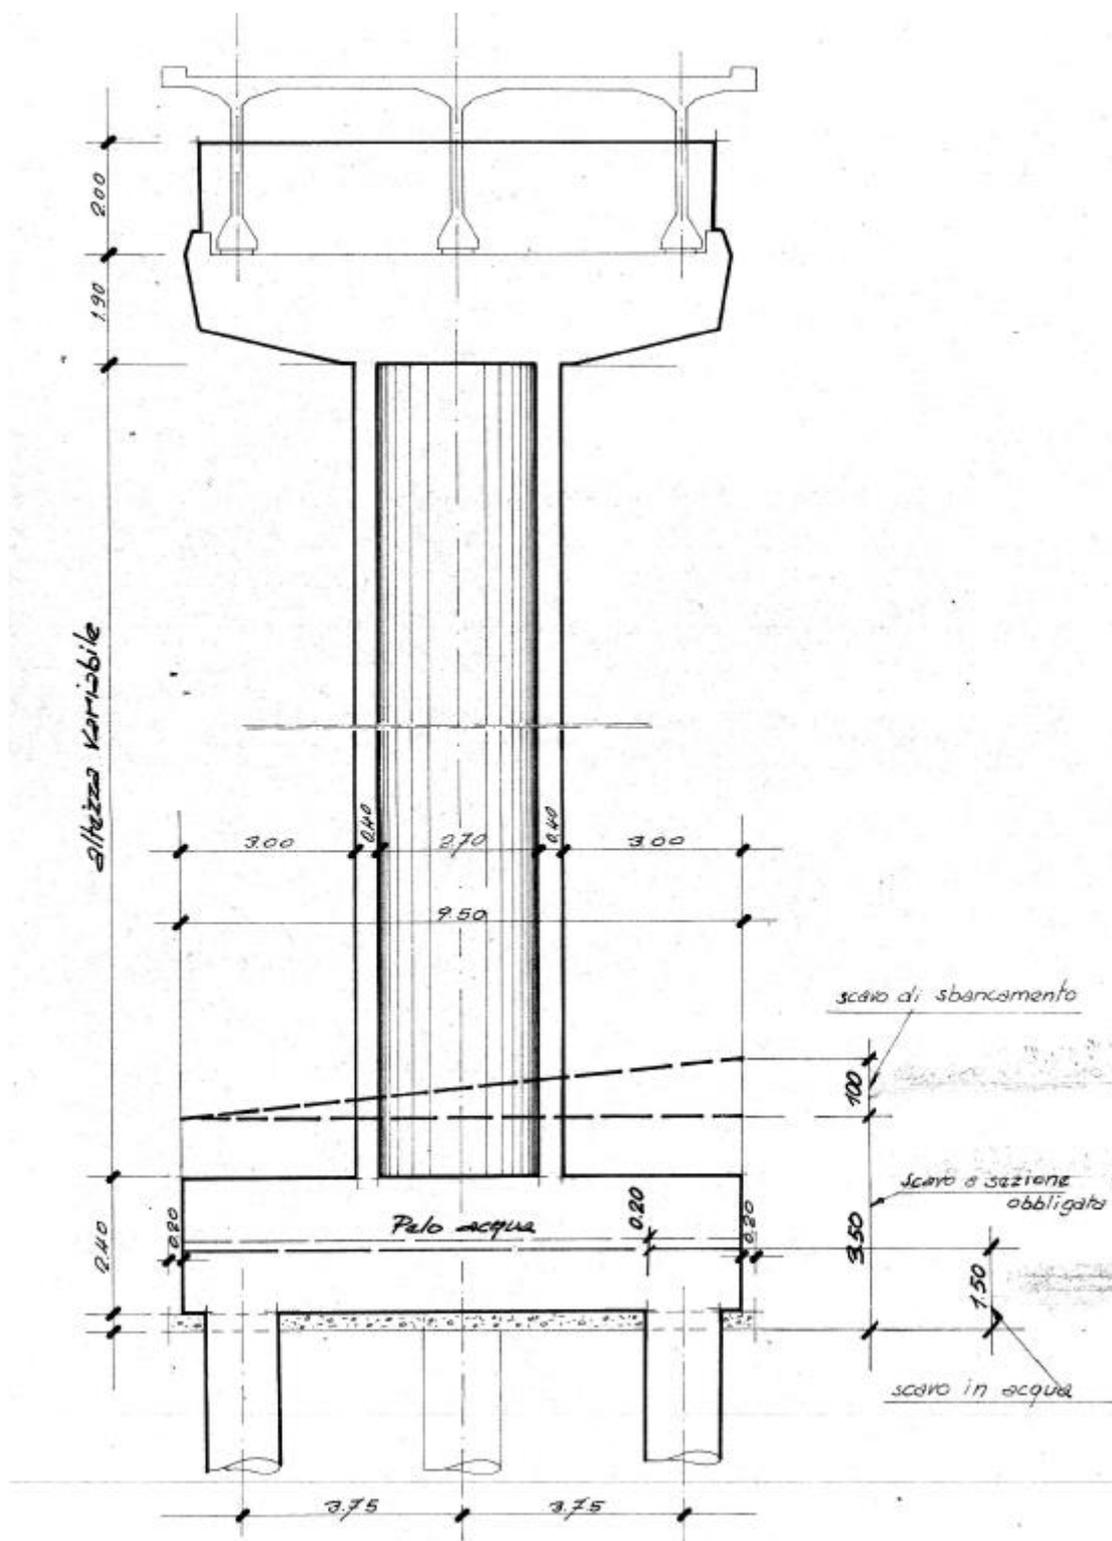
Impalcato a 3 travi in CAP – Sezione trasversale pile
